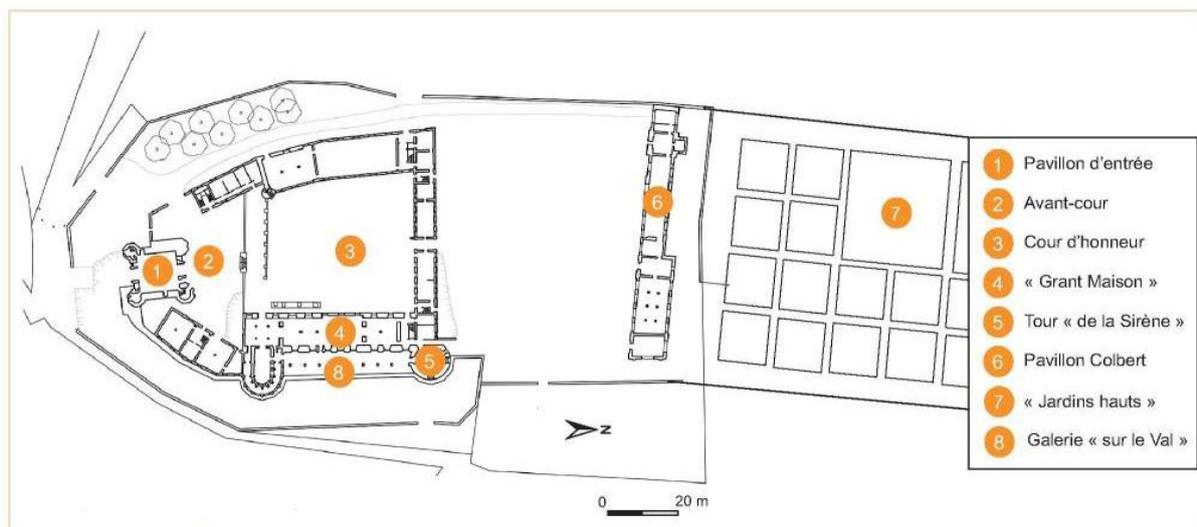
plan du rez-de-chaussée du château de Gaillon (document STAP 27 ; DAO : N. Bolo)
